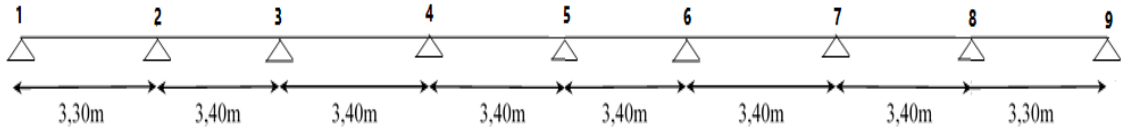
Schéma statique de la poutrelle à huit travées
